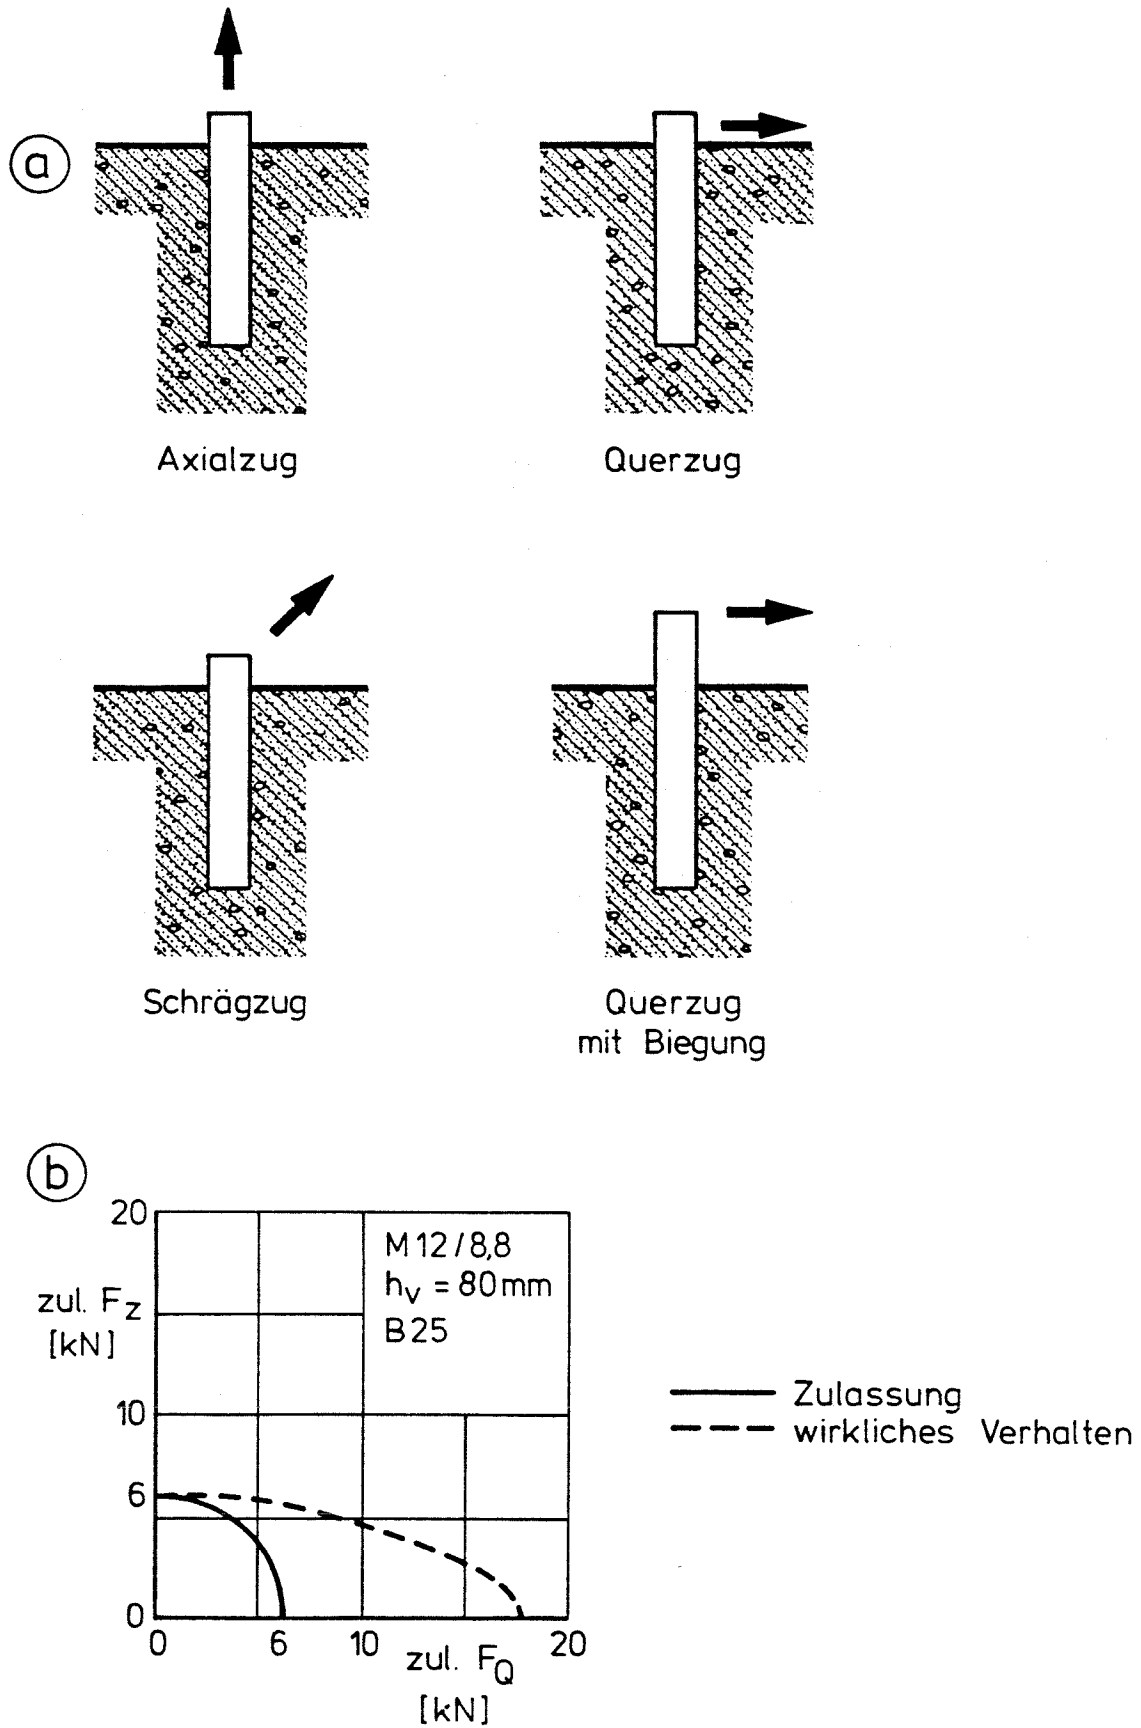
Beanspruchung von Dübeln. a) Beanspruchungsrichtungen, b) Interaktionsdiagramm für Dübel M 12 in gerissenem Beton unter Axial- und Querzug, nach [5]
